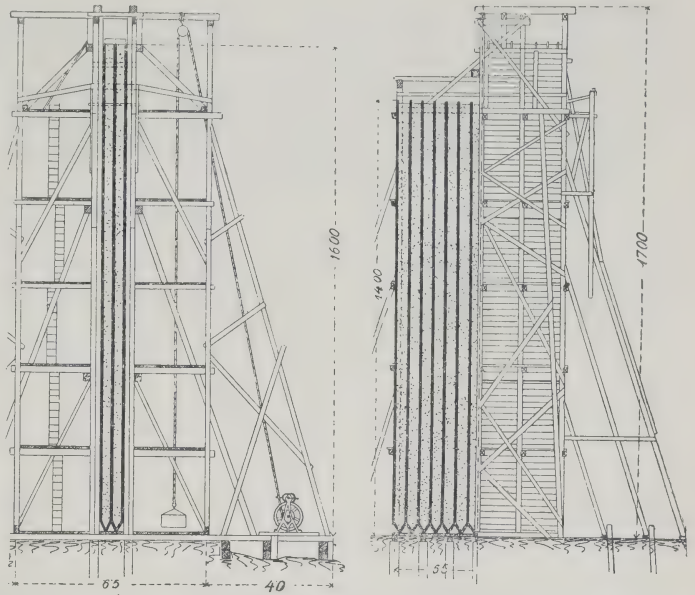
Gerüst zur vertikalen Einbetonierung von Pfählen.
